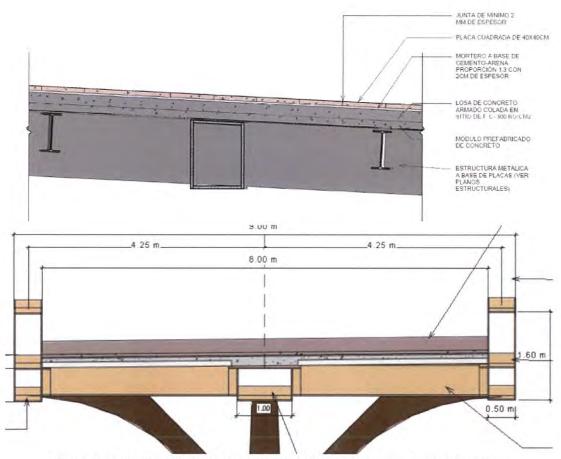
Corte longitudinal y transversal del sistema de piso a lo largo de la pasarela.
